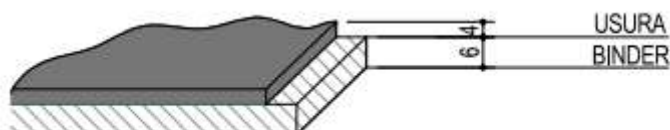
Particolare del Pacchetto 1 di rifacimento pavimentazione stradale
